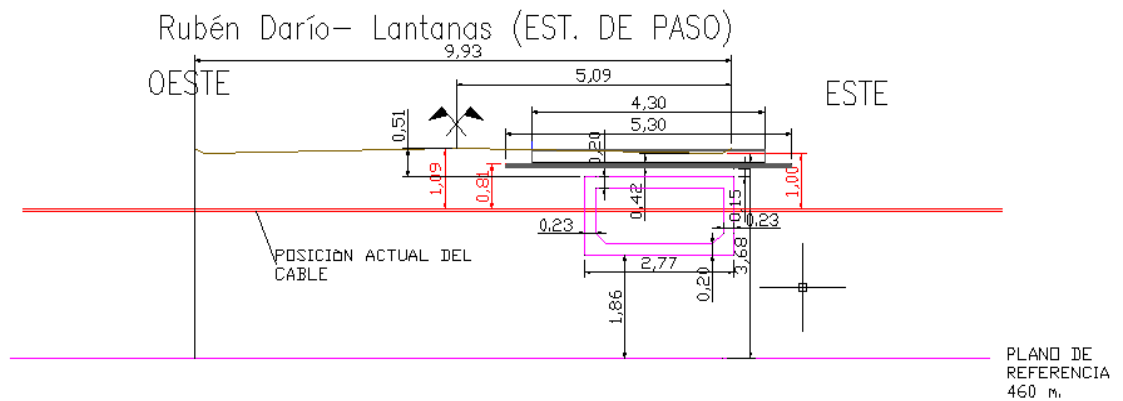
Corte- Estructura de paso propuesta. EDET RD-L.
